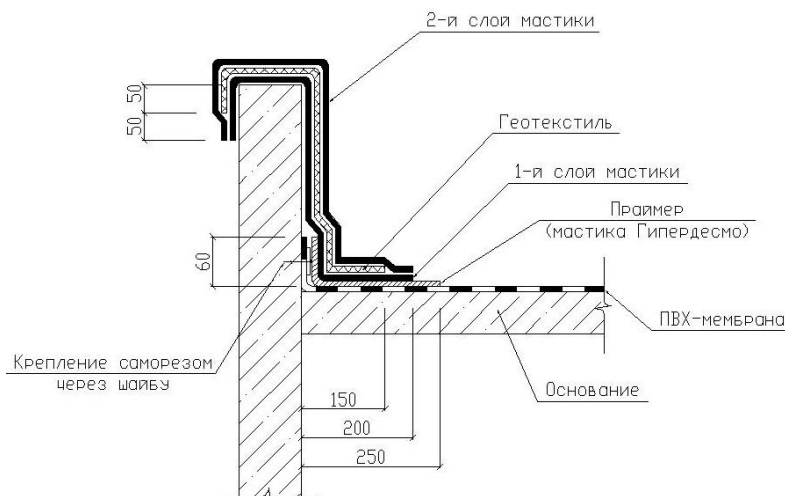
Устройство гидроизоляции примыкания к низкому парапету для случая, когда на горизонте кровли уложена полимерная мембрана (ПВХ или ЭПДМ).
